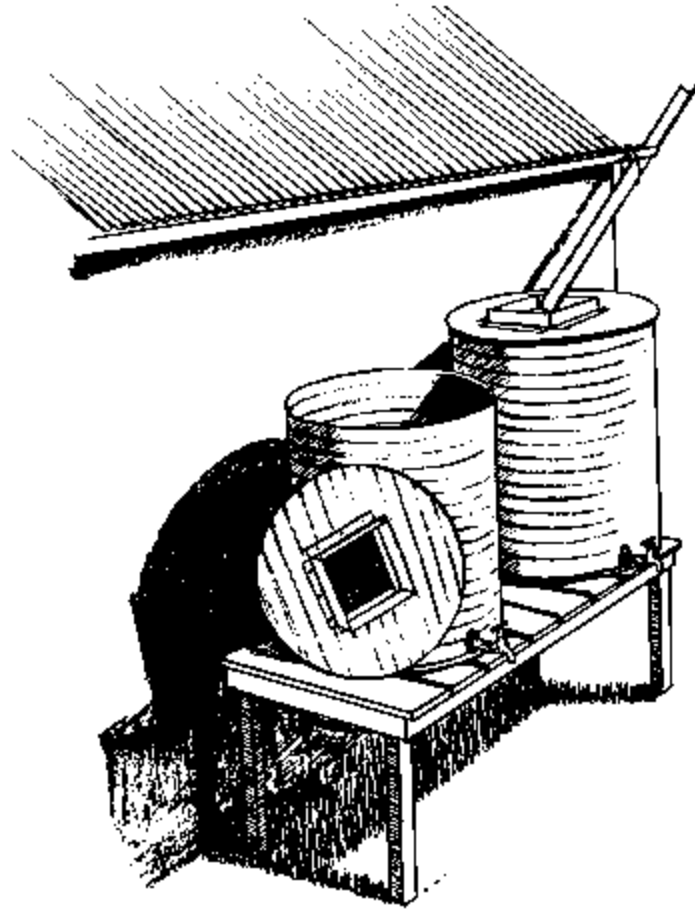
Couvercle fixe avec ouverture grillagée.
